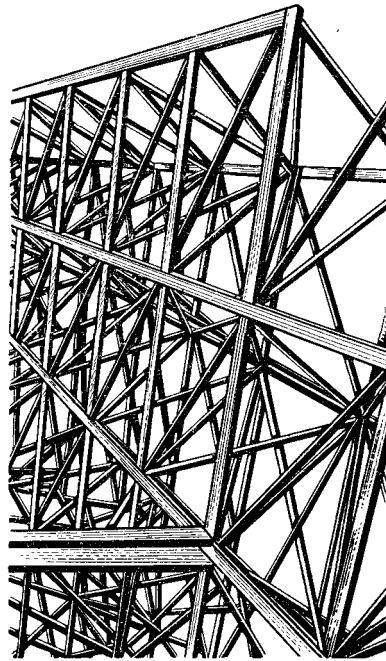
Фермы, сваренные точечной сваркой
